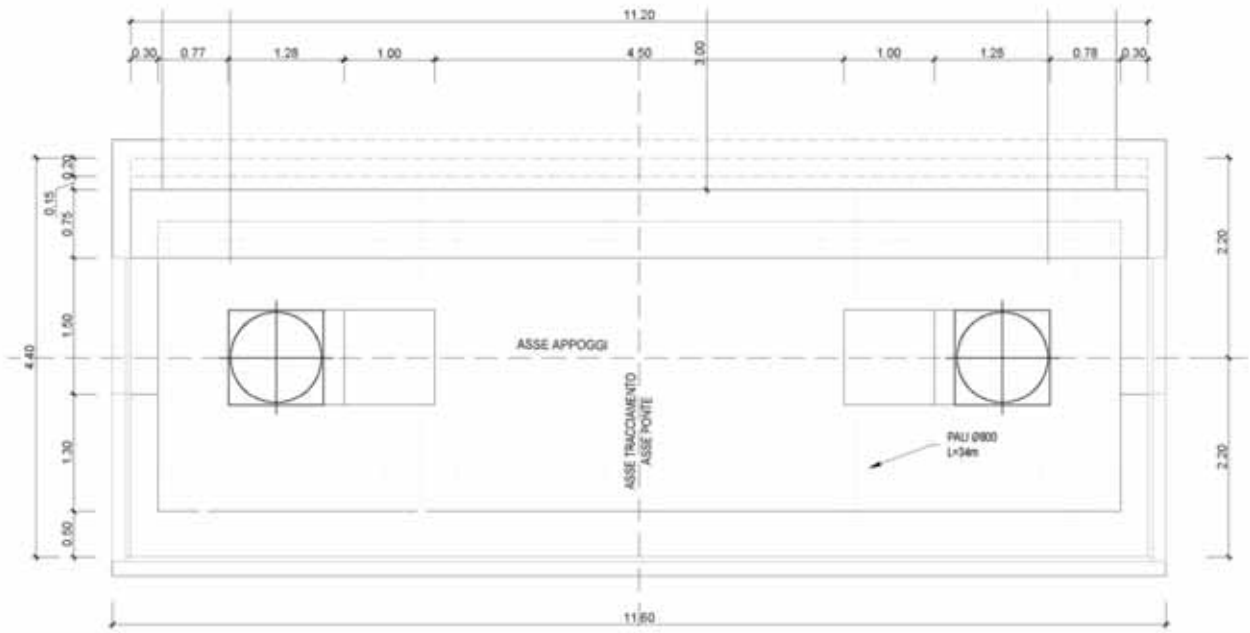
Pianta fondazione spalla Sx e della spalla Dx
